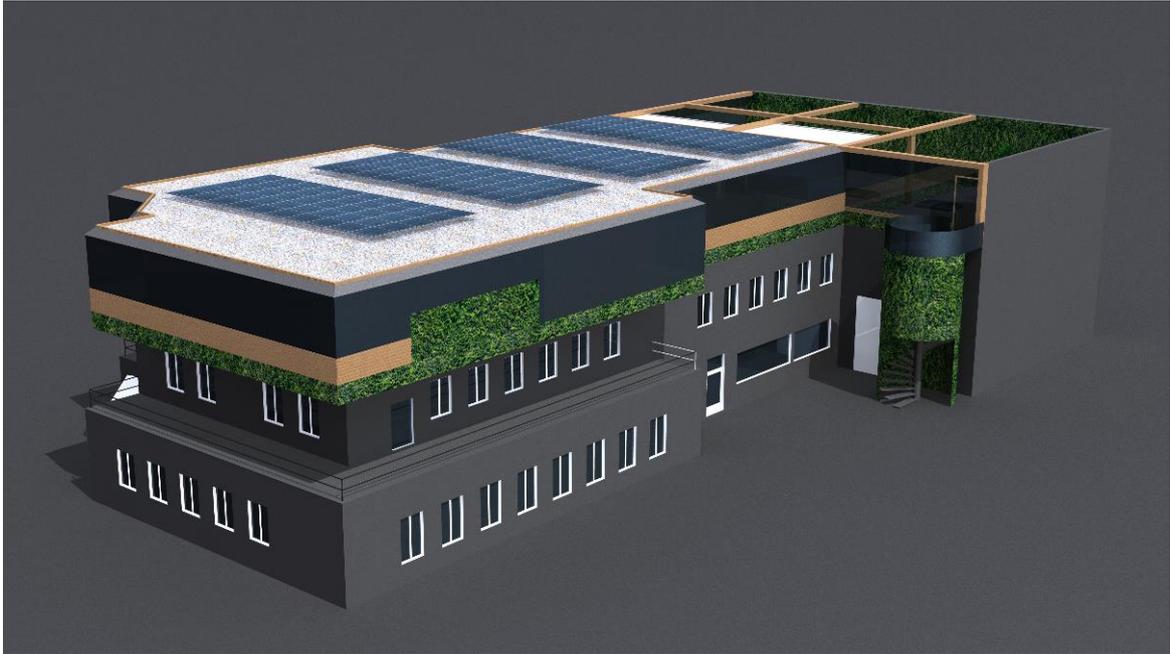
Haupthaus plus Fassadengestaltung in Farbgebung und Holz mit Fassadenanimation Rendering Finale Terrassenlösung
